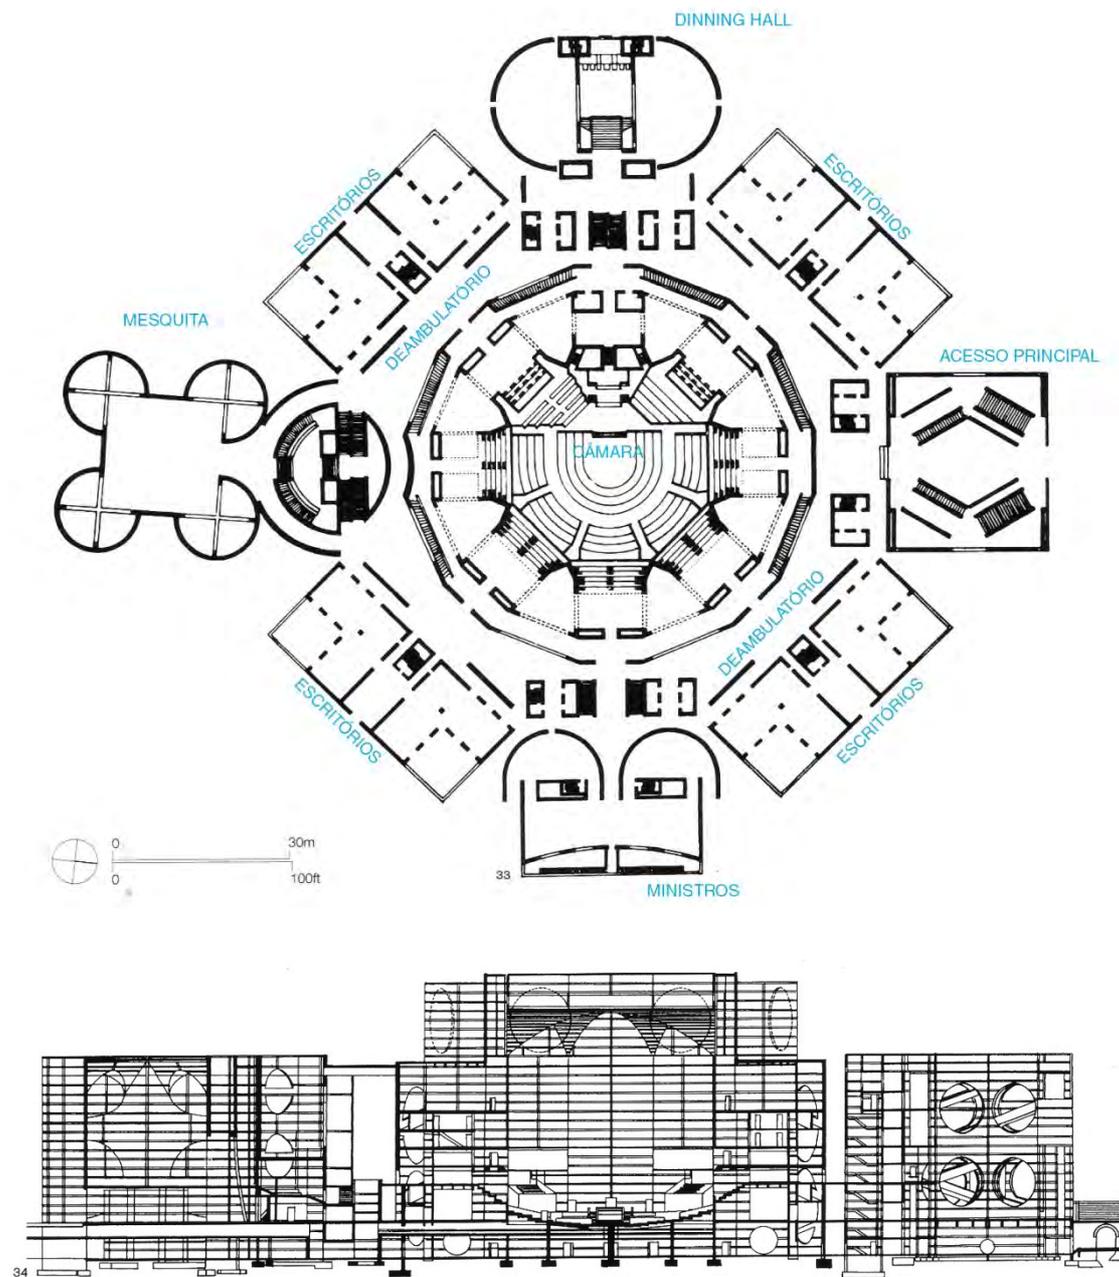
| Planta do térreo e corte do edifício da Assembleia [McCARTER]
